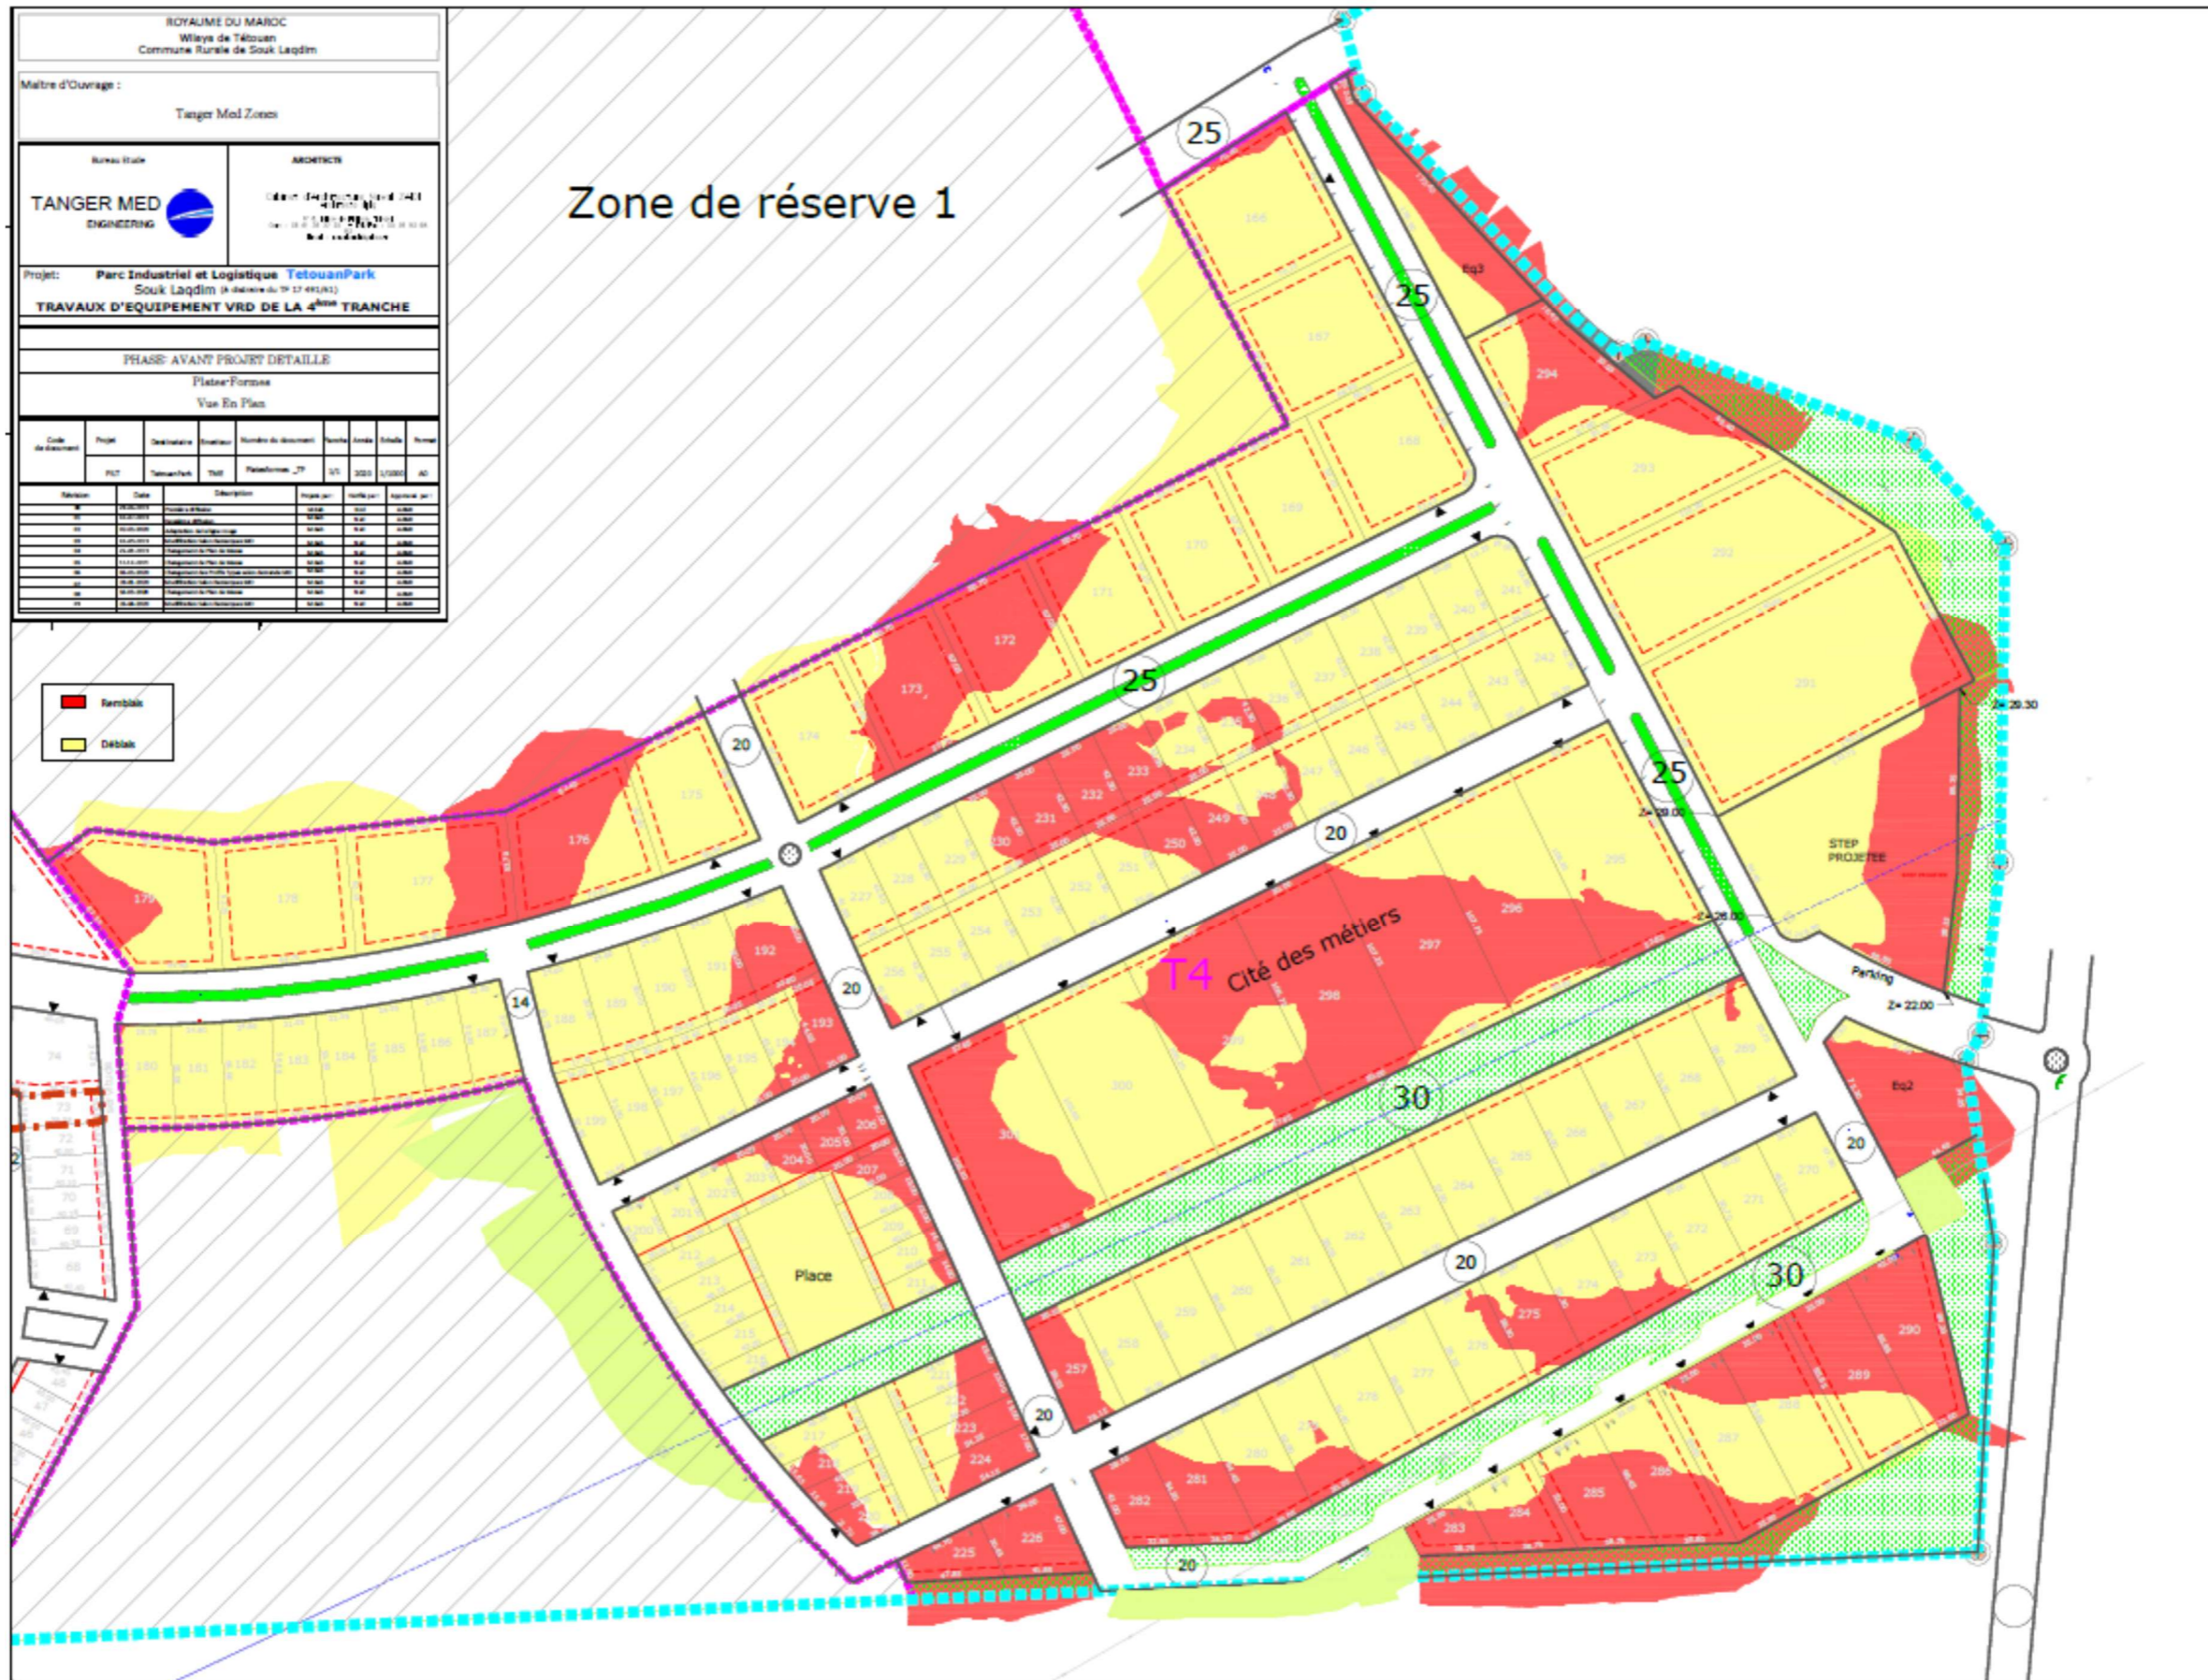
plan de mouvement de terres (Remblai / Déblais)
